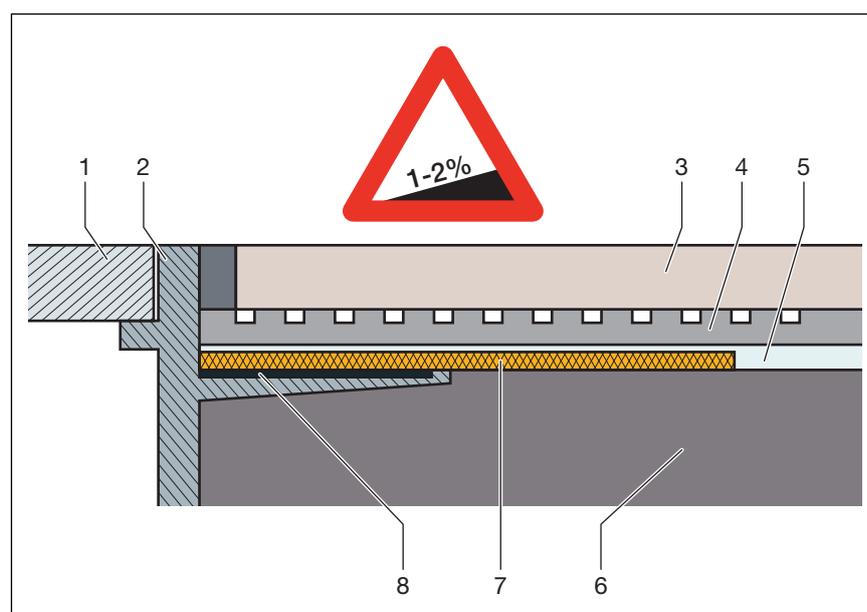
Schema di montaggio per impermeabilizzante fluido — pendenza massetto min. 1-2%
